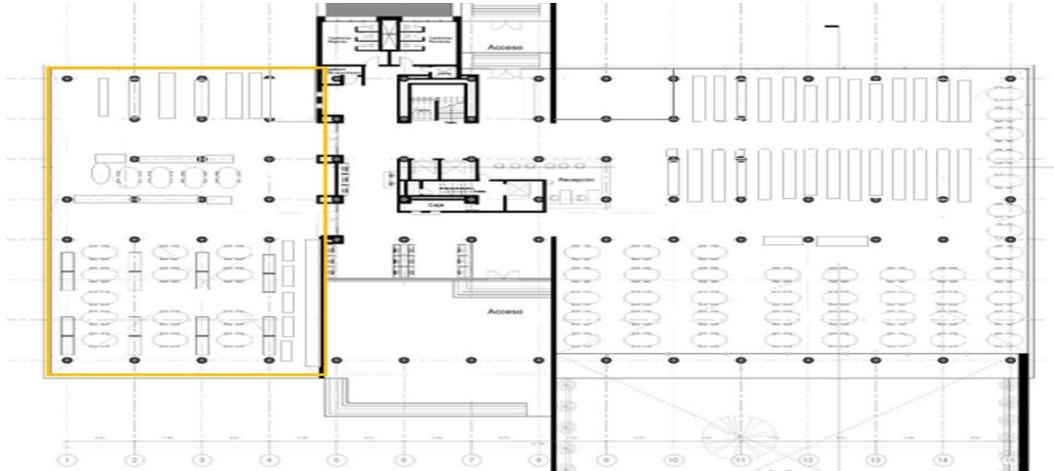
Sala de consulta de la planta principal de la Biblioteca Central ubicada de lado poniente
